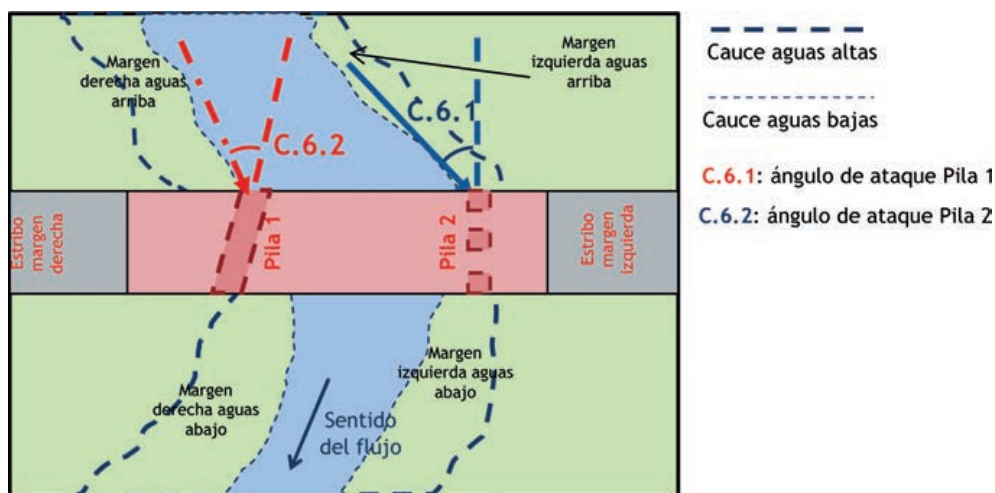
ÁNGULO DE ATAQUE SOBRE LAS PILAS.
